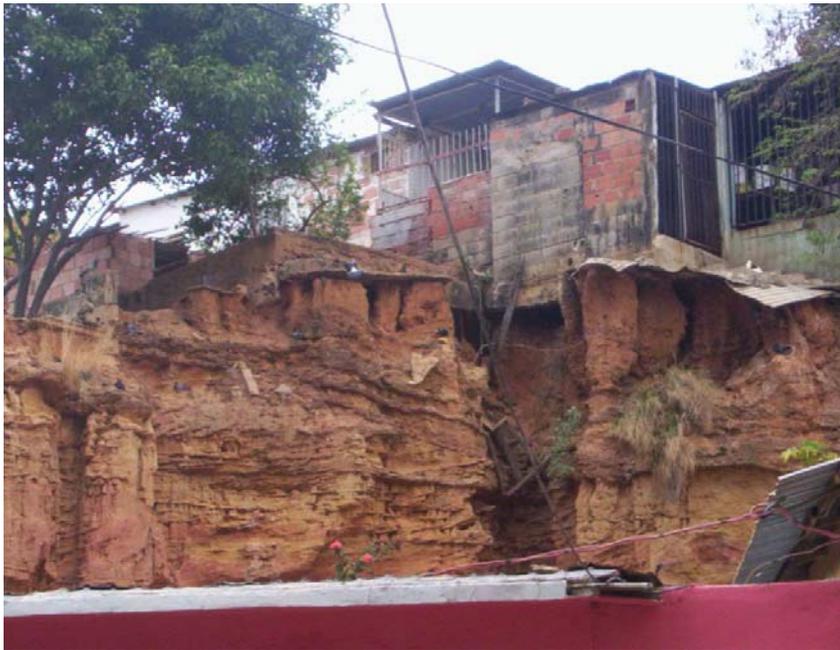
Vivienda artesanal sin soporte estructural al borde del talud. Barrio Cerros de Marín, Municipio Maracaibo, estado Zulia
